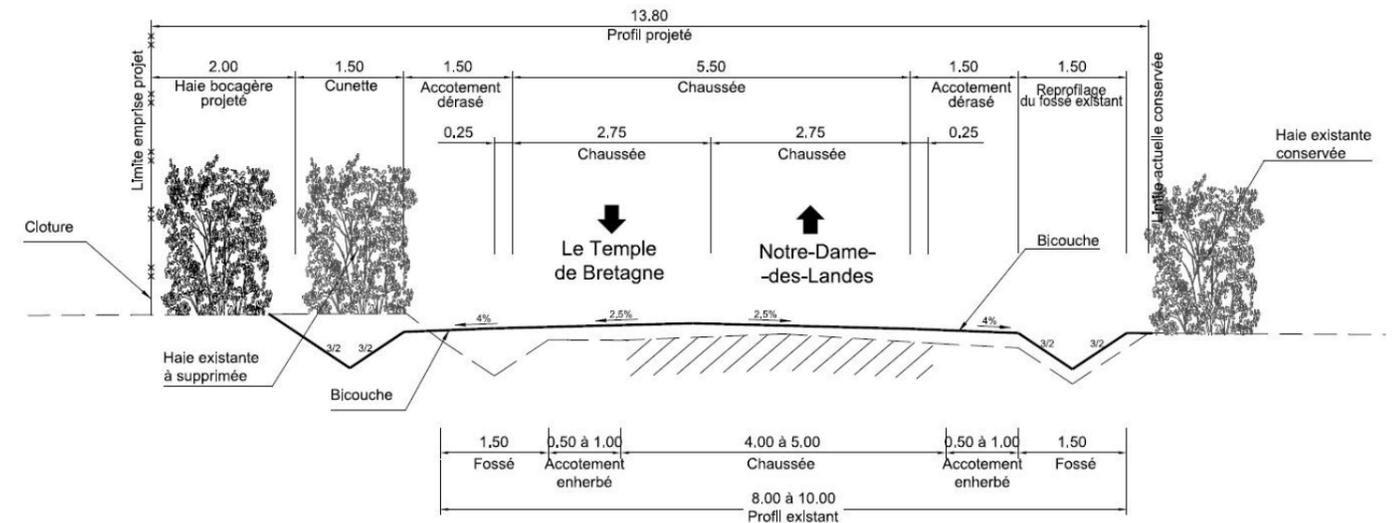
Section courante – Profil en travers de la VC1-VC12 – Elargissement côté gauche
